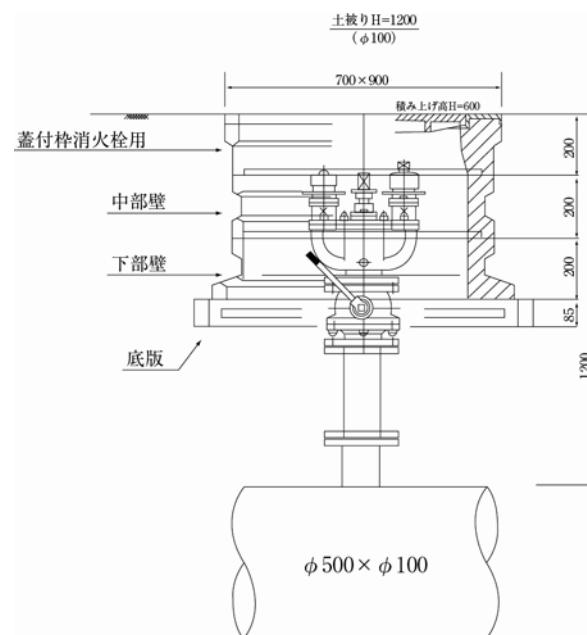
双口消火栓室の設置例 (単位: mm)
